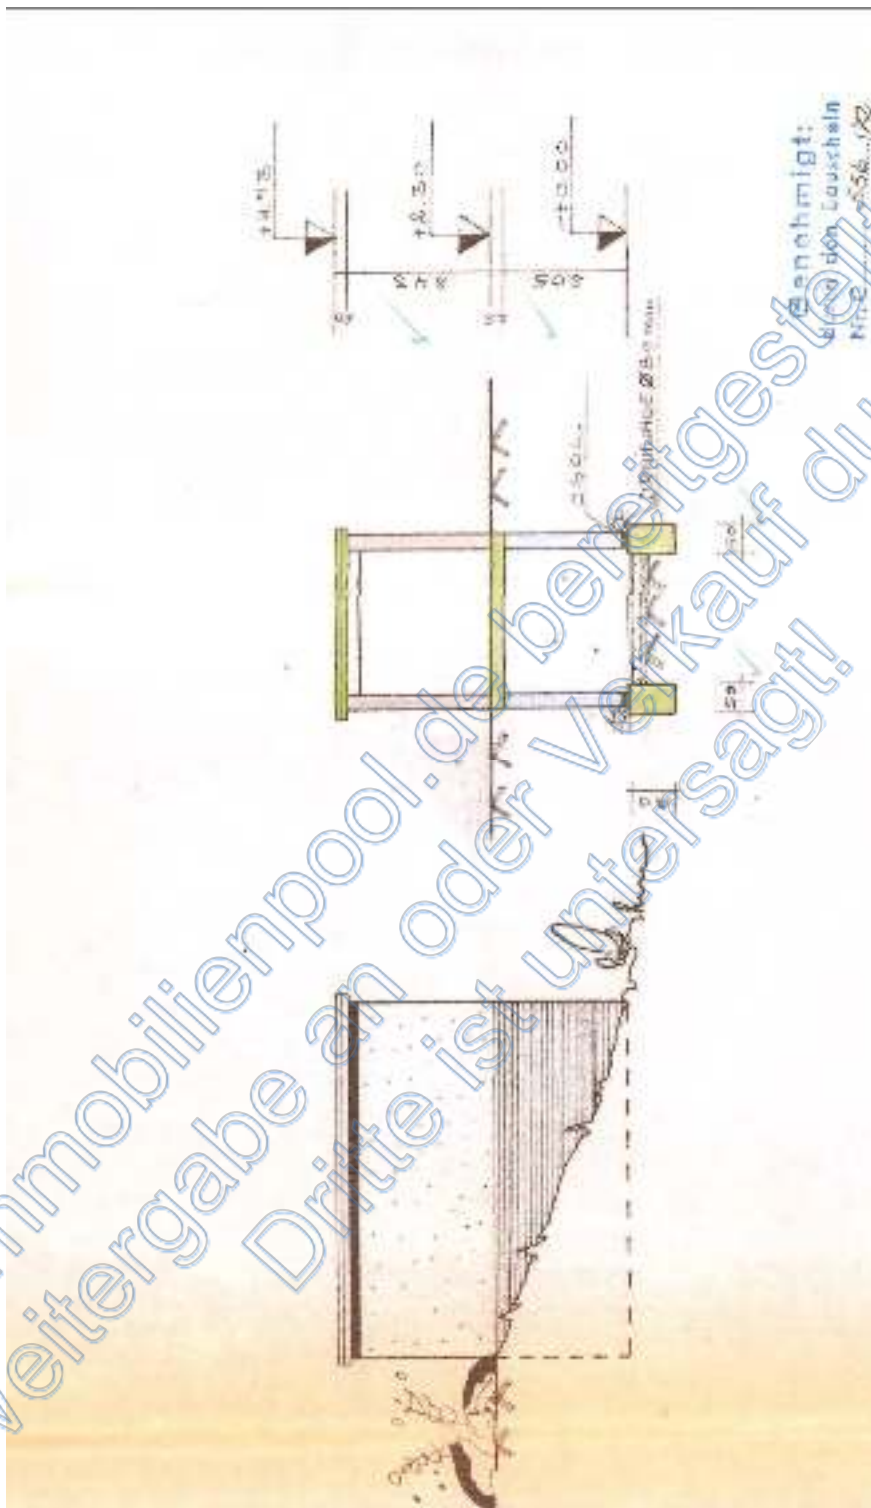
Bauzeichnung - Ansicht/Schnitt, Garage/Remise
